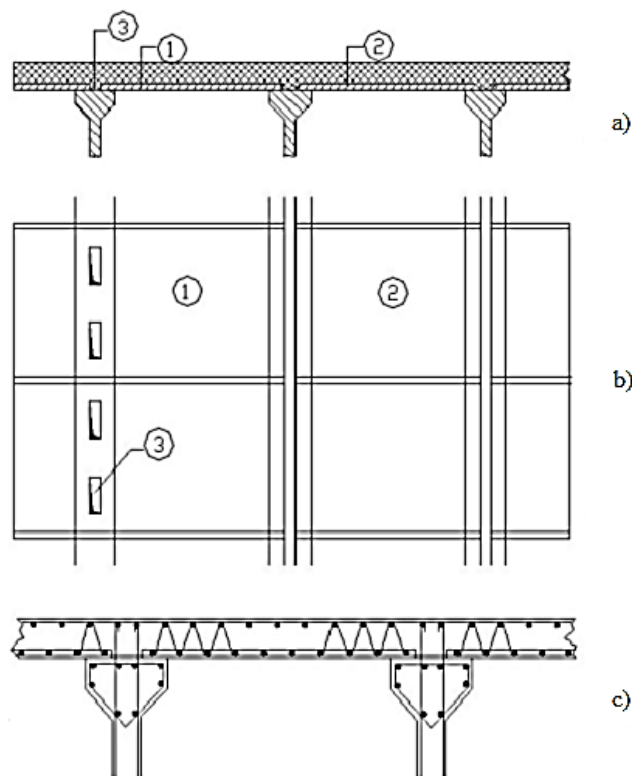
Ausführung von Plattenbalken mit einer Vorplatte: a) Schnitt, b) Grundriss, c) Bewehrungsplan, 1) Vorplatte: Fertigteil (Kragarm), 2) Vorplatte: Fertigteil (zweiseitig gestützt), 3) „Öffnung“
